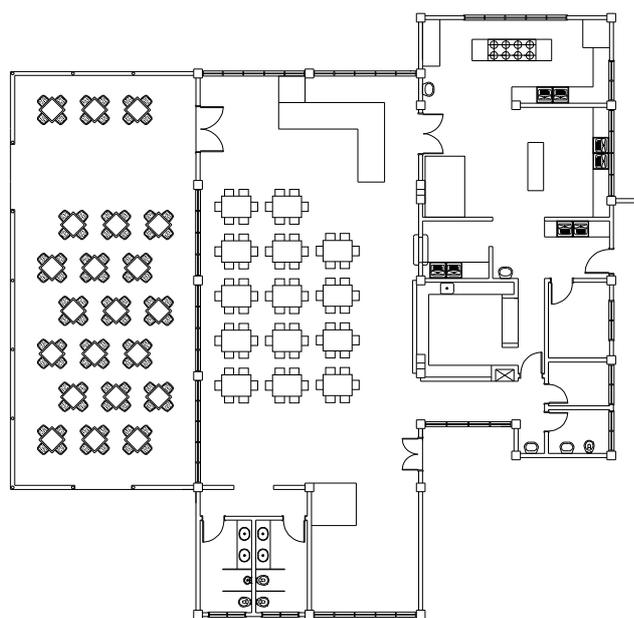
Planta Baixa do Projeto Arquitetônico do Restaurante
